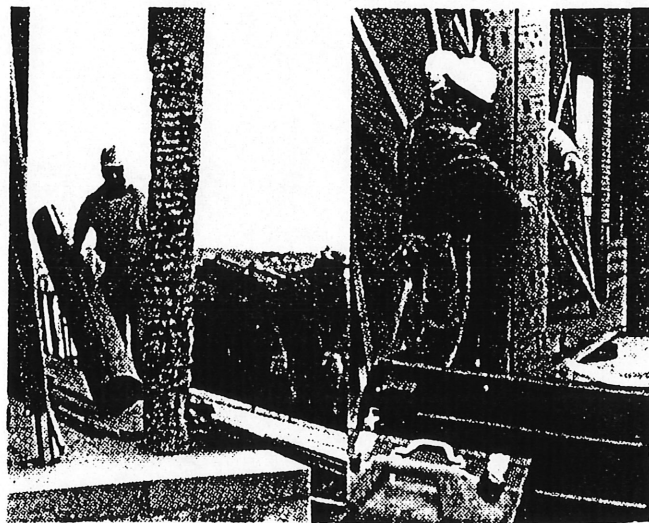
Renforcement de poteaux à l'Université de Sherbrooke
